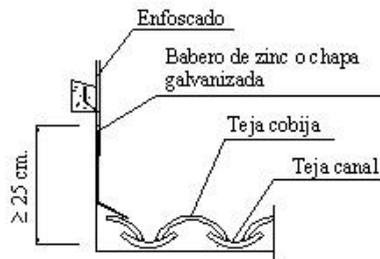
Detalle babero. 2015. Fuente: J.C.A.
